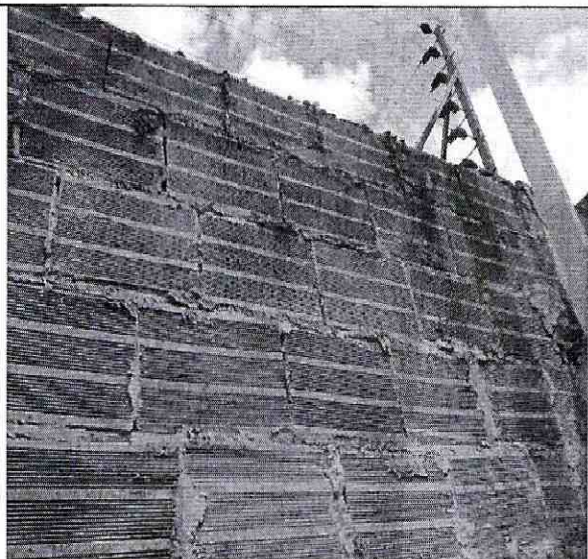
Algunas fisuras en la pega entre bloques.
